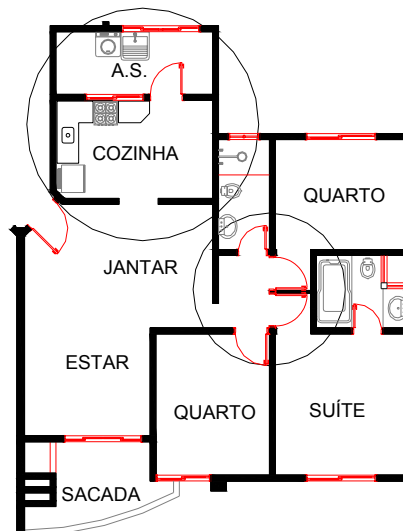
Planta Baixa do apartamento 401 - Estudo de caso D.
